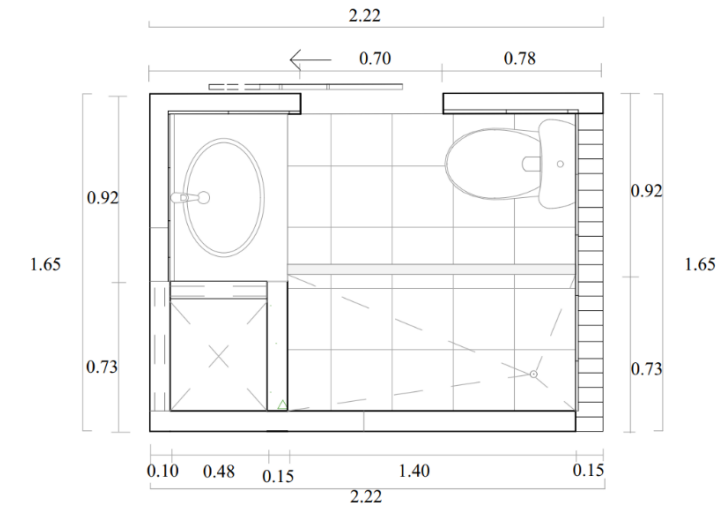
Detalle constructivo de baño de persona invidente - vista en planta
